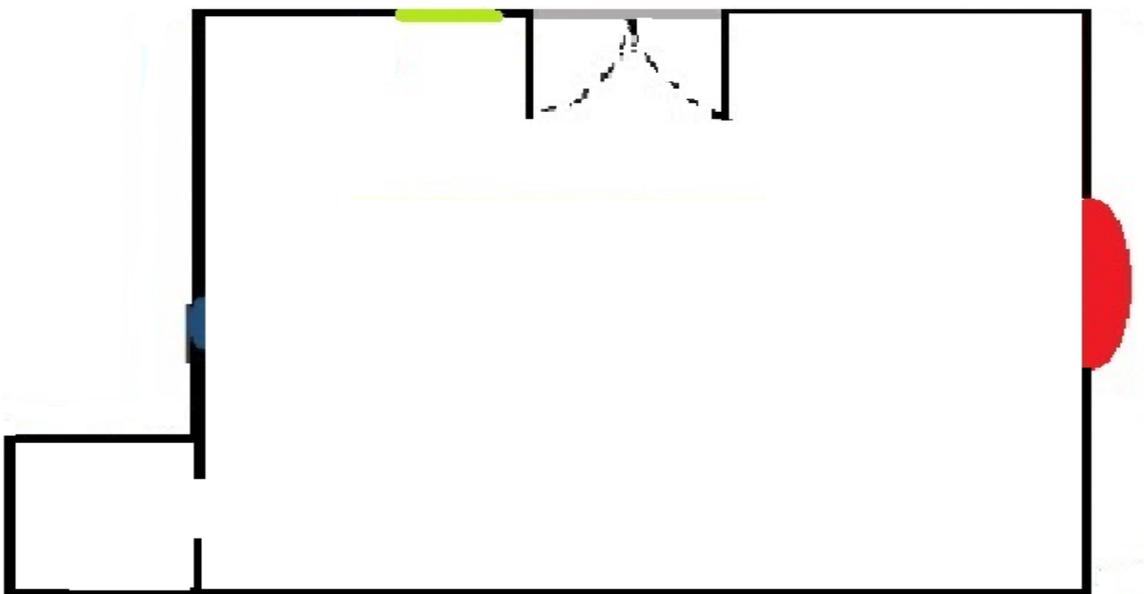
Plano del depósito del MACEW. Con la ventana, color rojo, las puertas y la colocación de la caja eléctrica, color verde.
